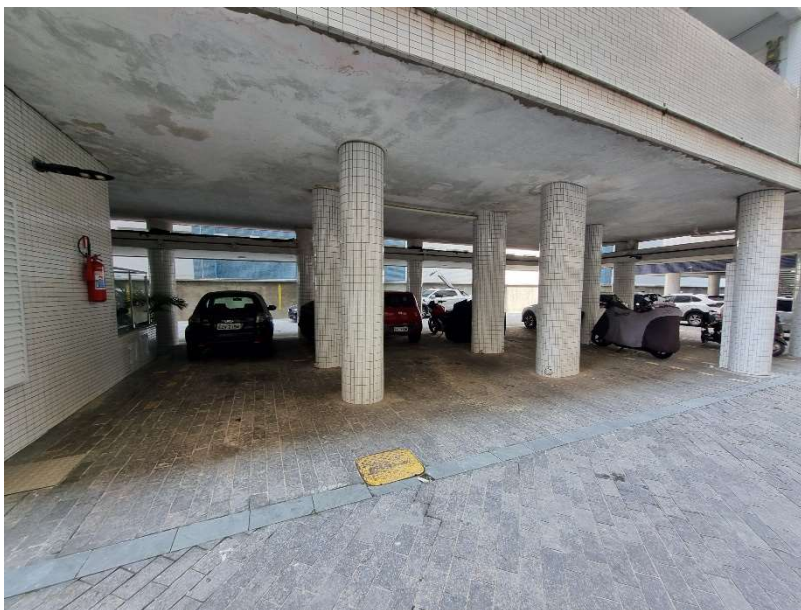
Vista da garagem do pavimento térreo do Edifício Marajá Mandarin.
